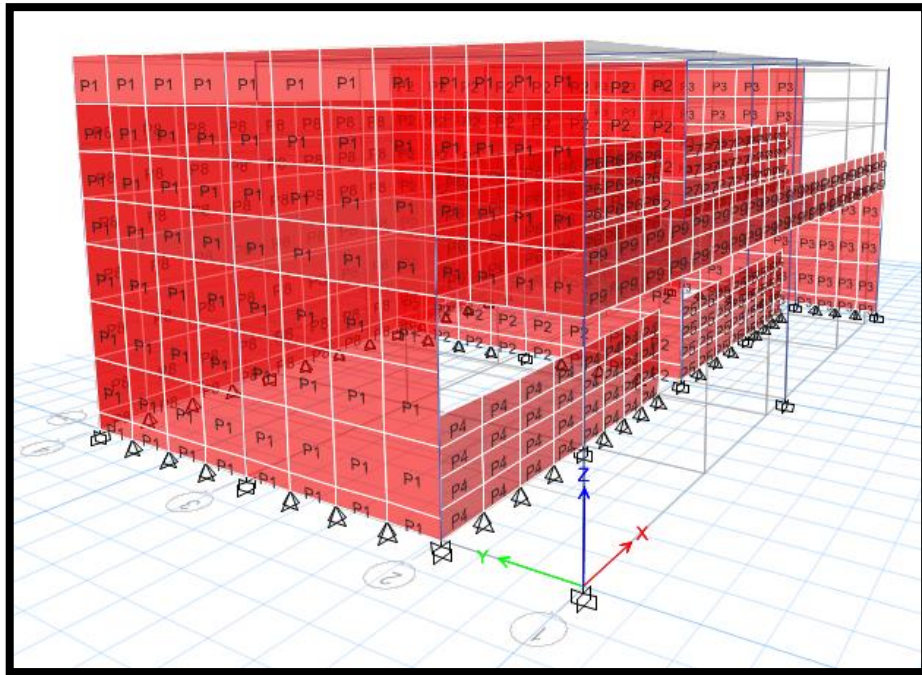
Modelo 3D de muros de albañilería con “Pier Label” en ETABS
